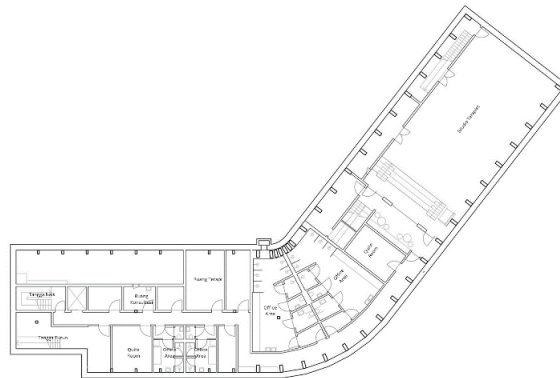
First Floor Plan Center for Health, Copenhagen, Denmark
